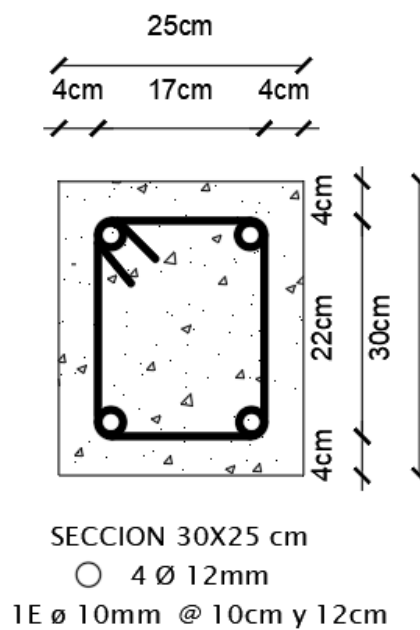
Armado de la viga de hormigón, estructura de acero.
